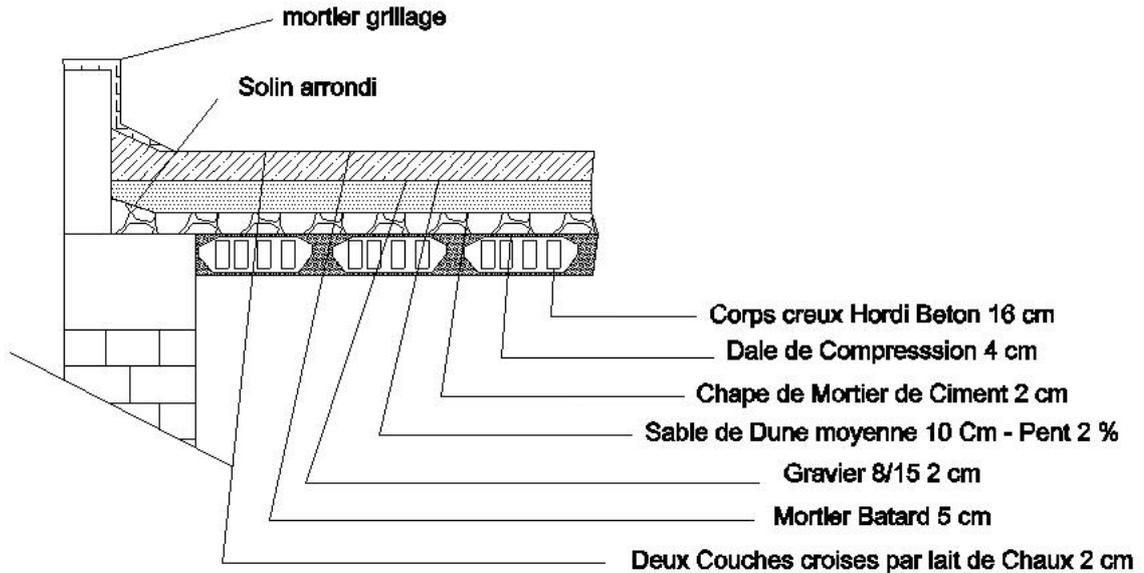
Les conches d'un planchers en zone saharienne selon le DTR modifier par AUTOCAD [Auteurs]
